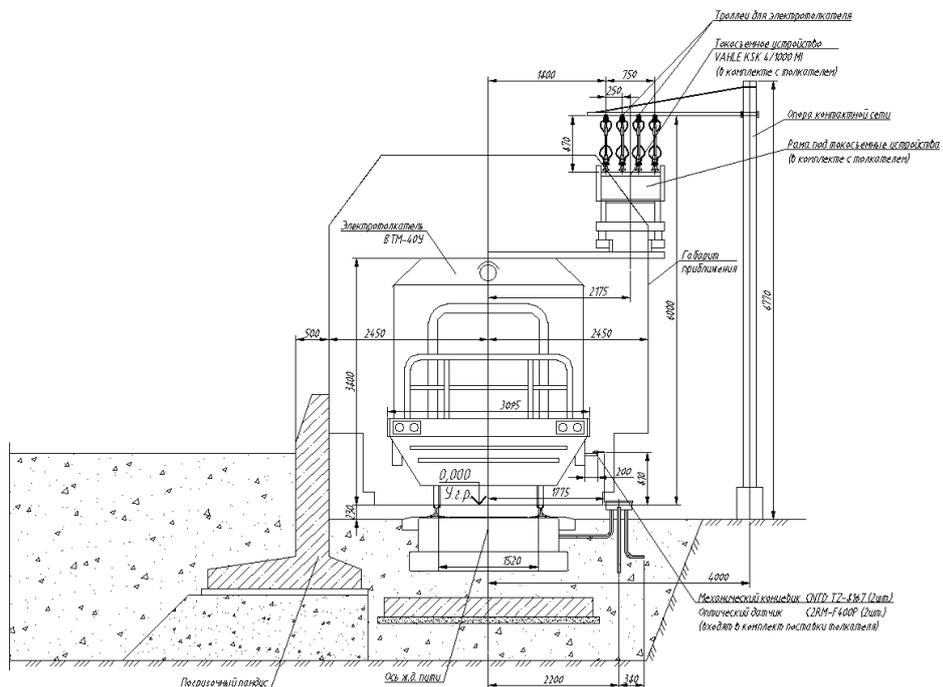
Схема бокового расположения троллей для электротолкателя ВТМ-40У
